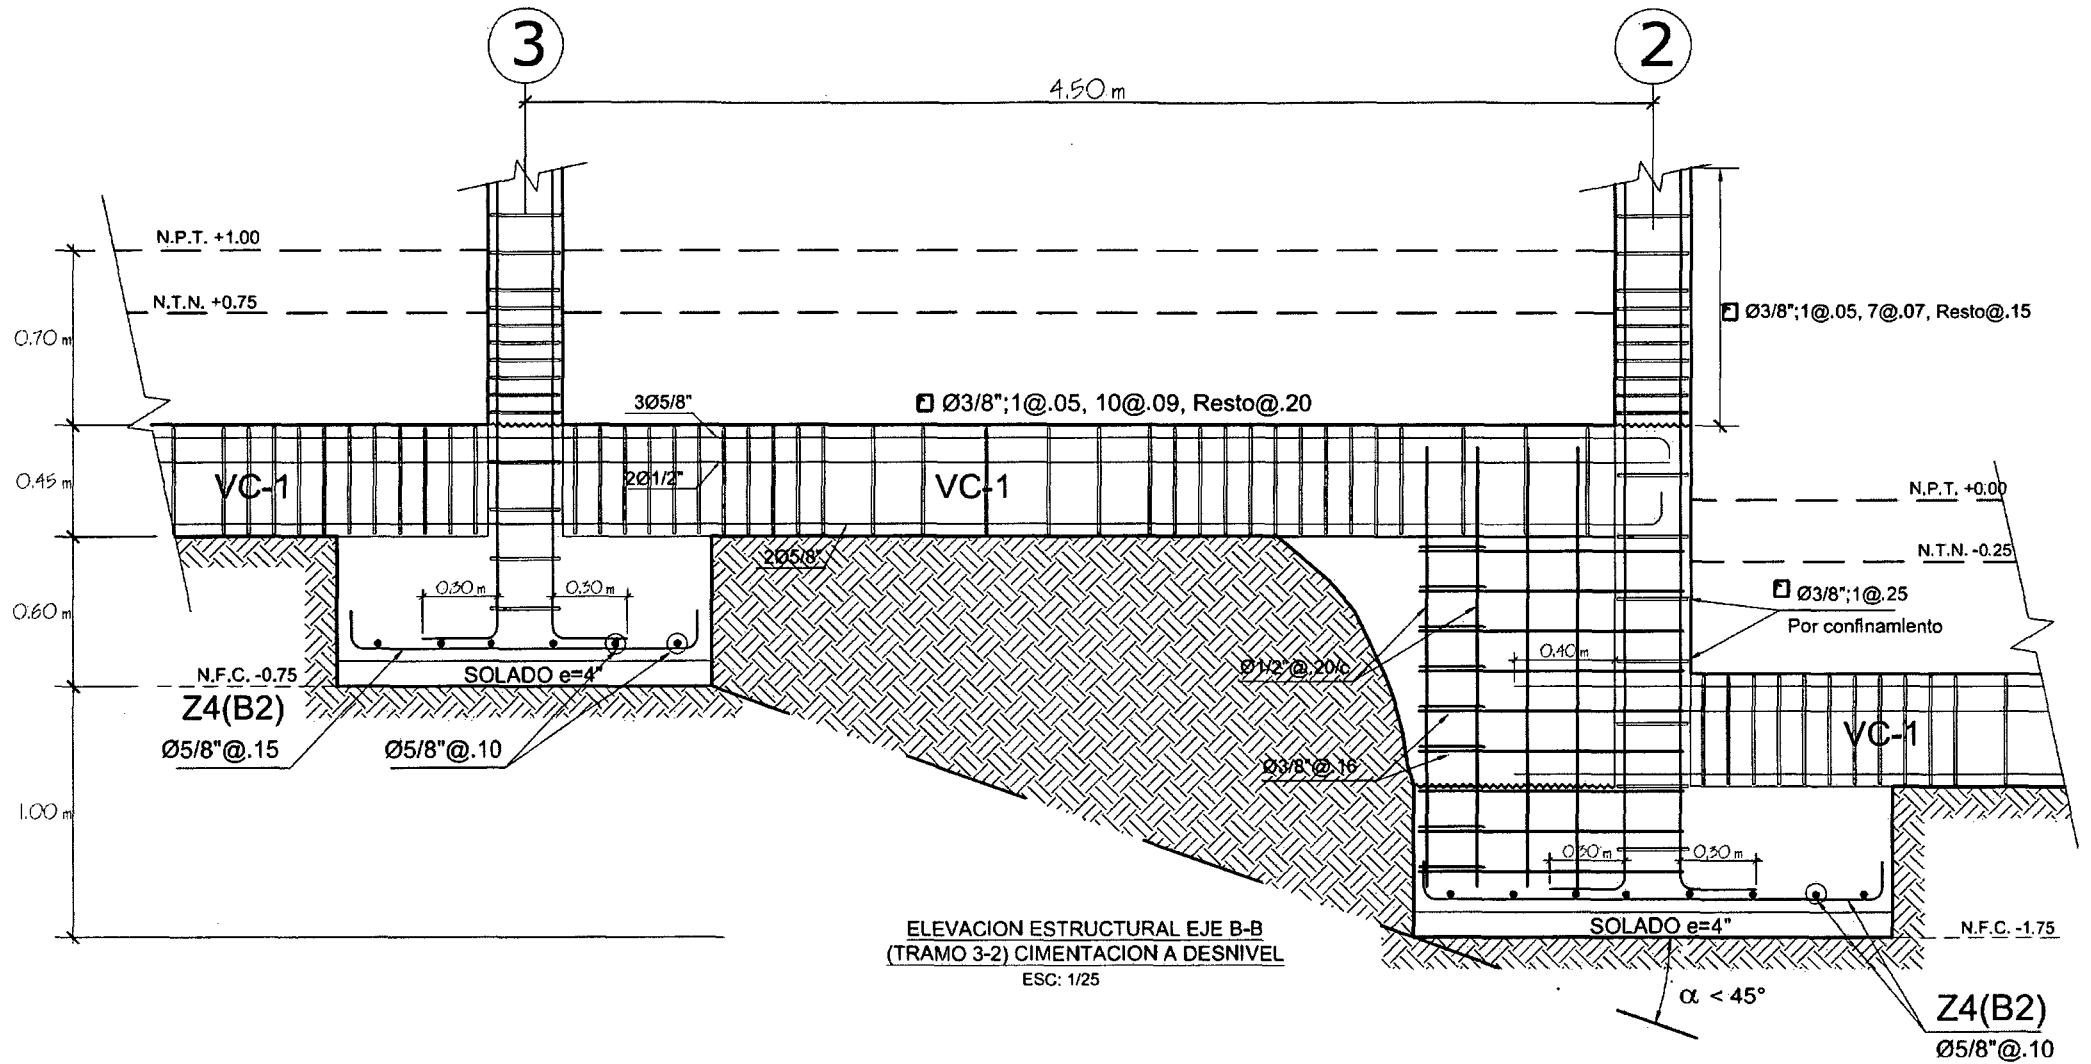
Distribución de refuerzo en cimentación a desnivel.
